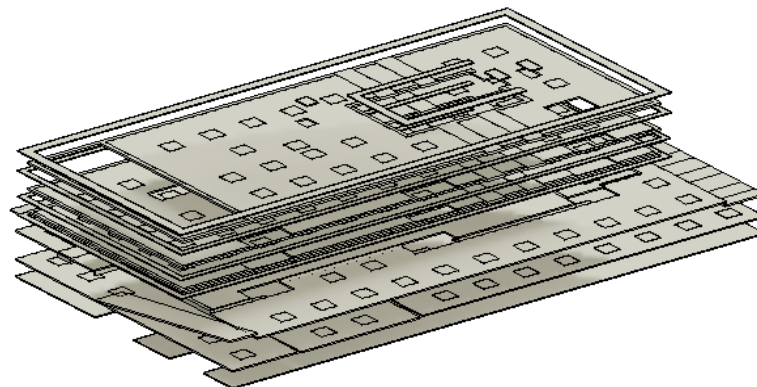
Laje, bandas e capitéis modelados no Revit
